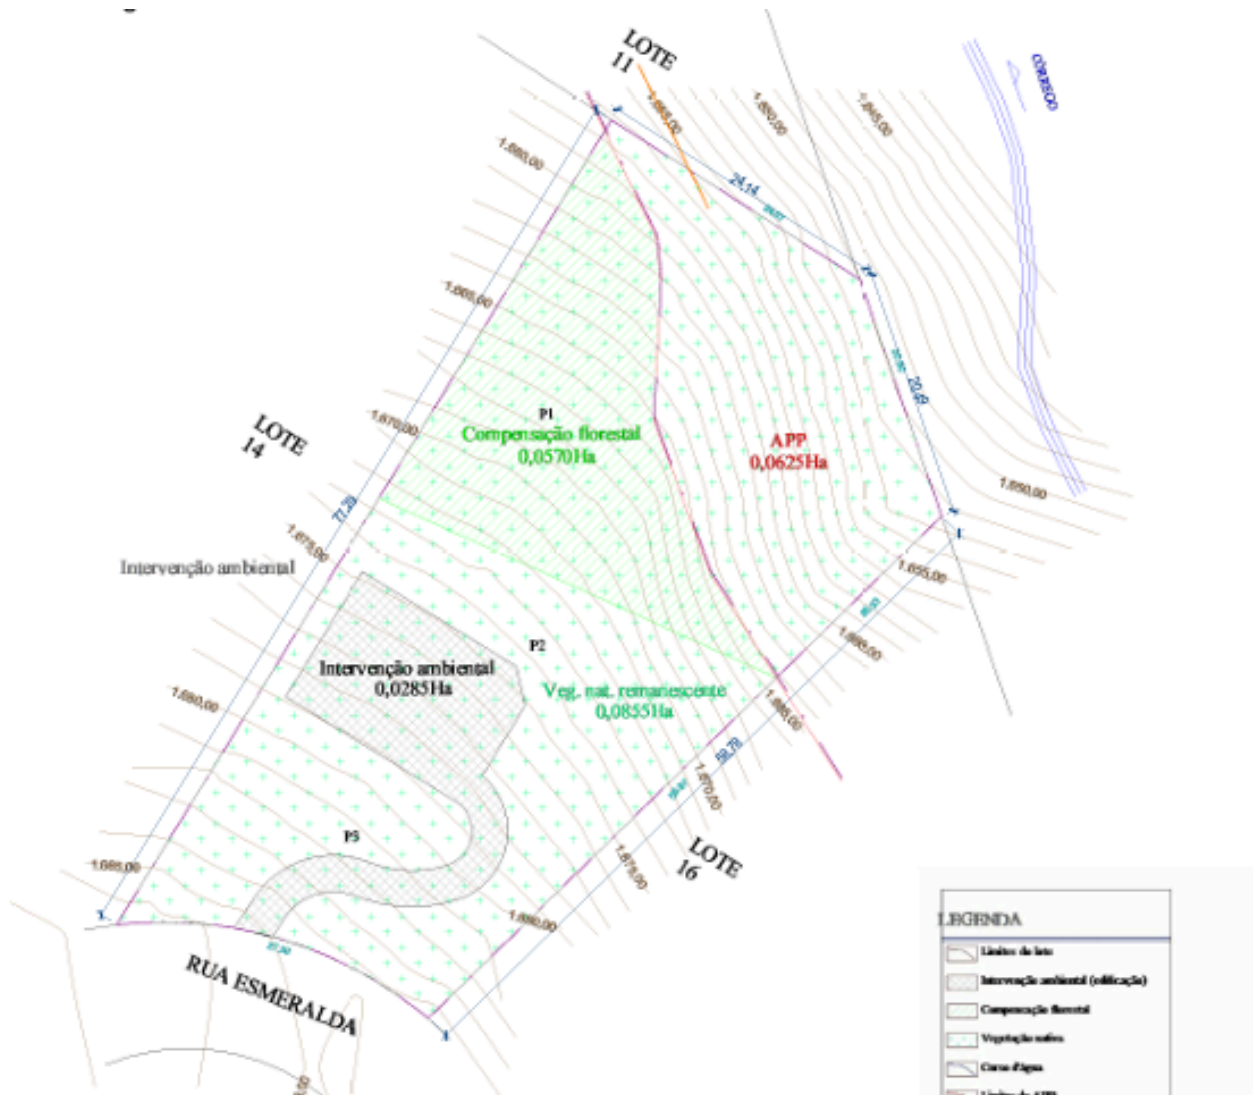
Planta topográfica do lote com a proposta de intervenção, conservação e compensação florestal.
